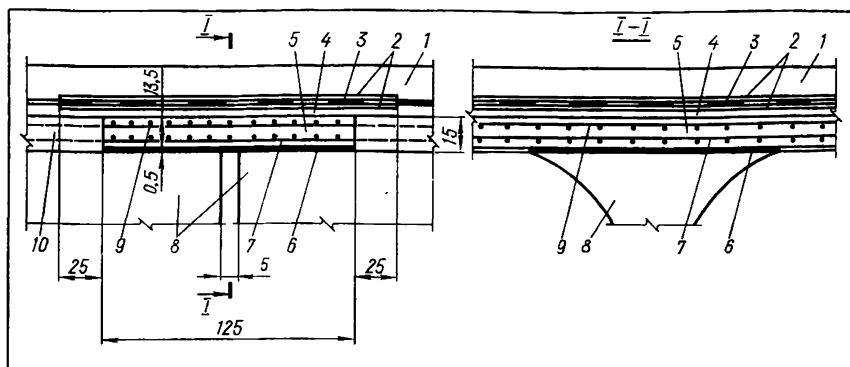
Армирование соединительной плиты при шарнирном соединении:
